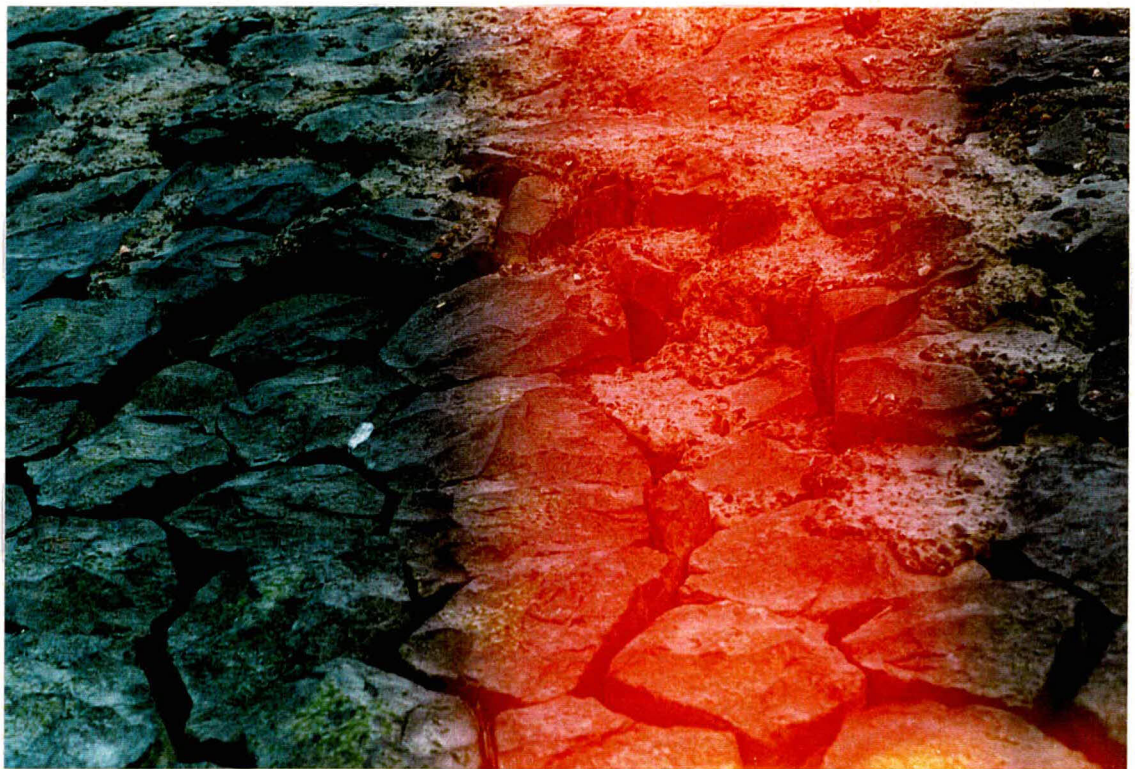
Voorbeeld van verzakte zuilen, kennelijk doordat er materiaal onder de zuilen vandaan kan spoelen. Dit is juist onder de (gepentreerde) overgangsconstructie.
